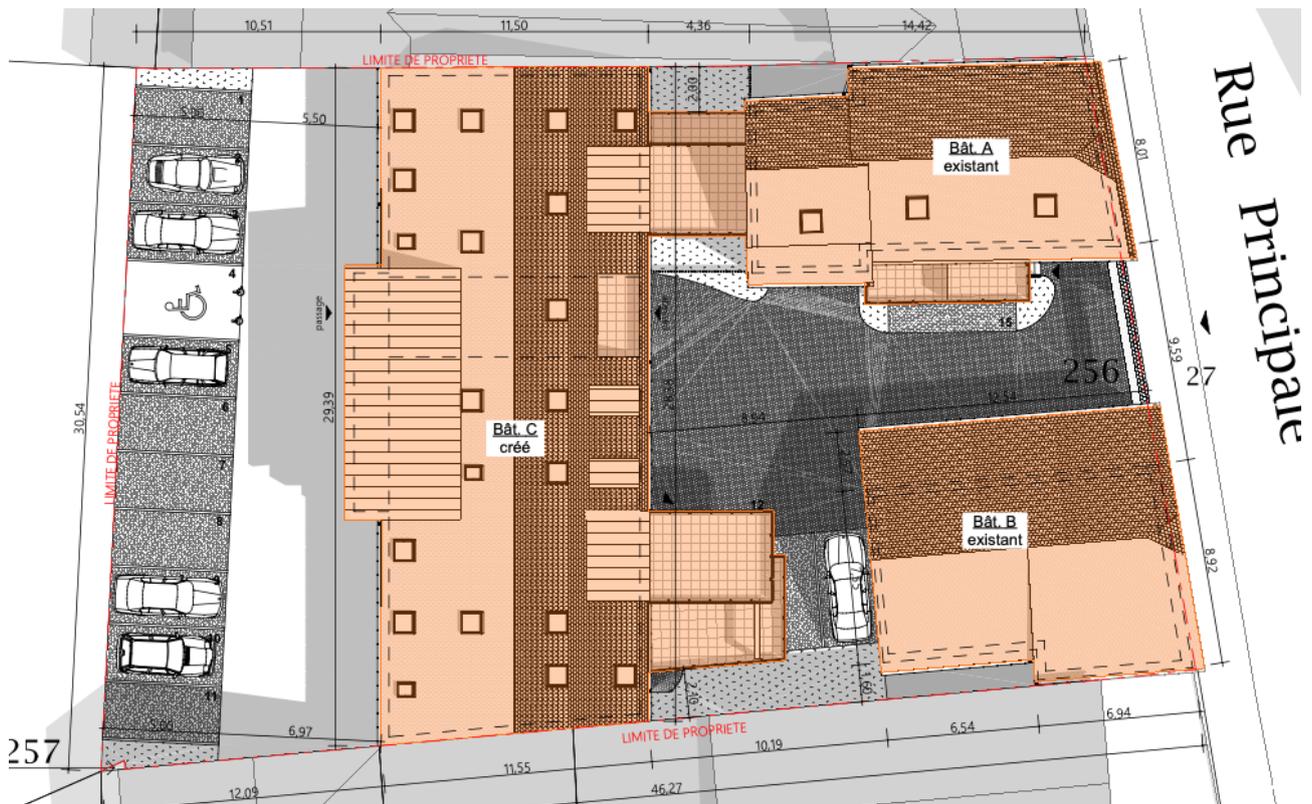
Plan de masse du projet – Source K+ Architecture globale
